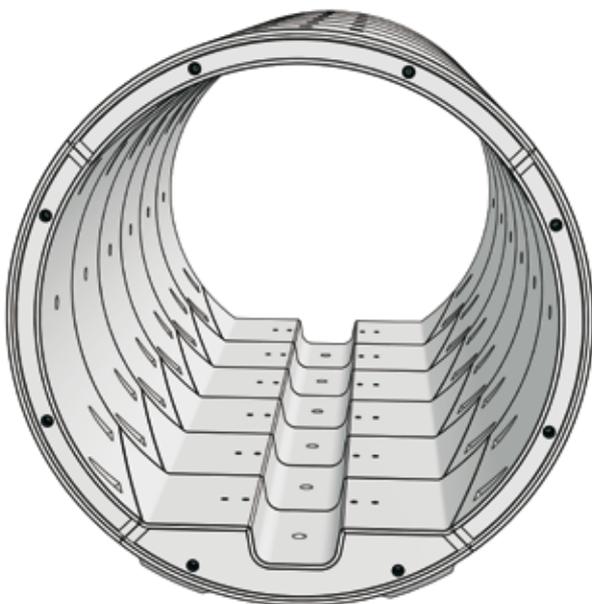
3D-Ansicht des Druckstollen nicht in Skala
